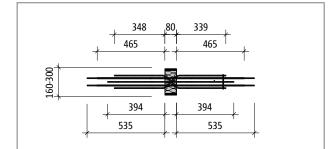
Schöck Isokorb® T type W-M1: Product layout
